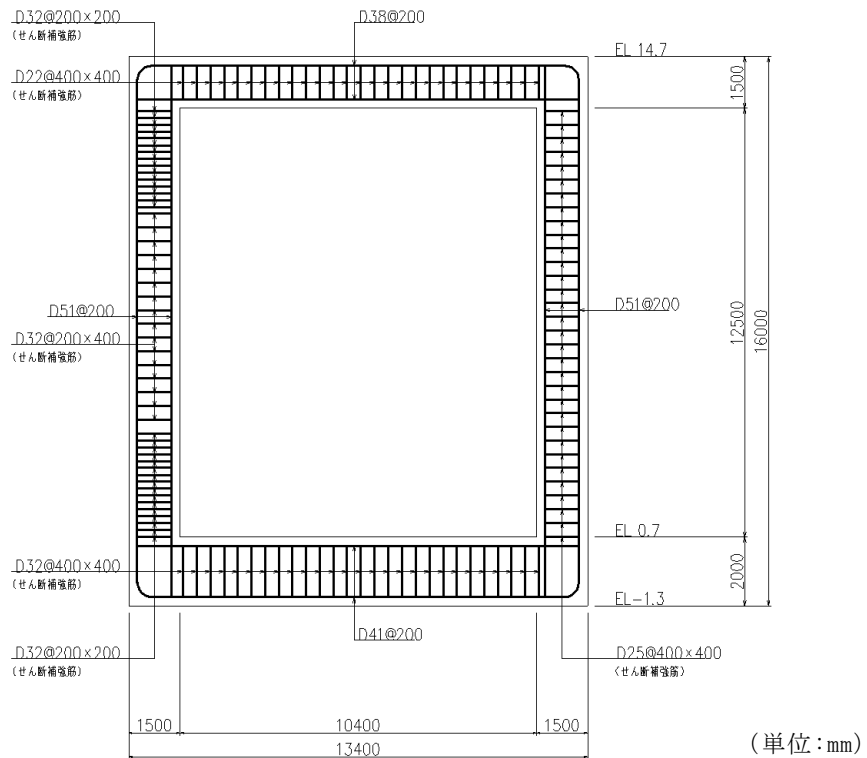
低圧原子炉代替注水ポンプ格納槽 概略配筋図 (B-B 断面)
